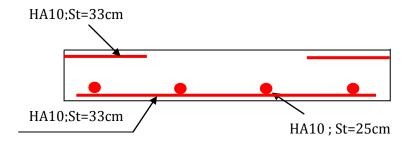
Vue en coupe du ferraillage de la dalle sur trois appuis
